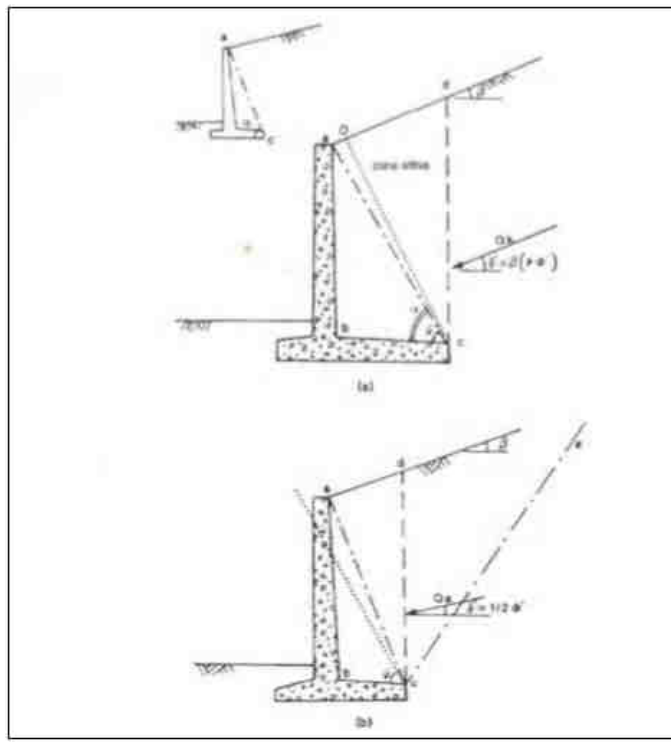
Spinta sui muri di sostegno a mensola con suola lunga (caso a) e con suola corta (caso b).
